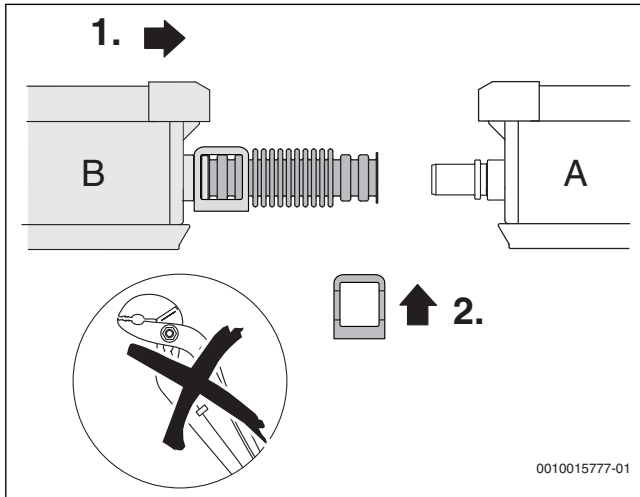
Colocar el colector izquierdo junto al colector derecho
